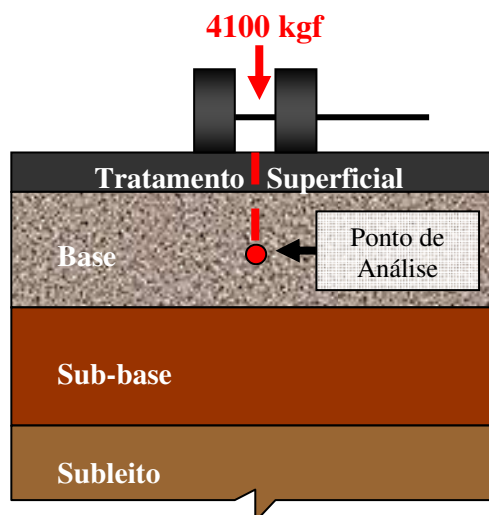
Estrutura de pavimento hipotética considerada na análise do MR
